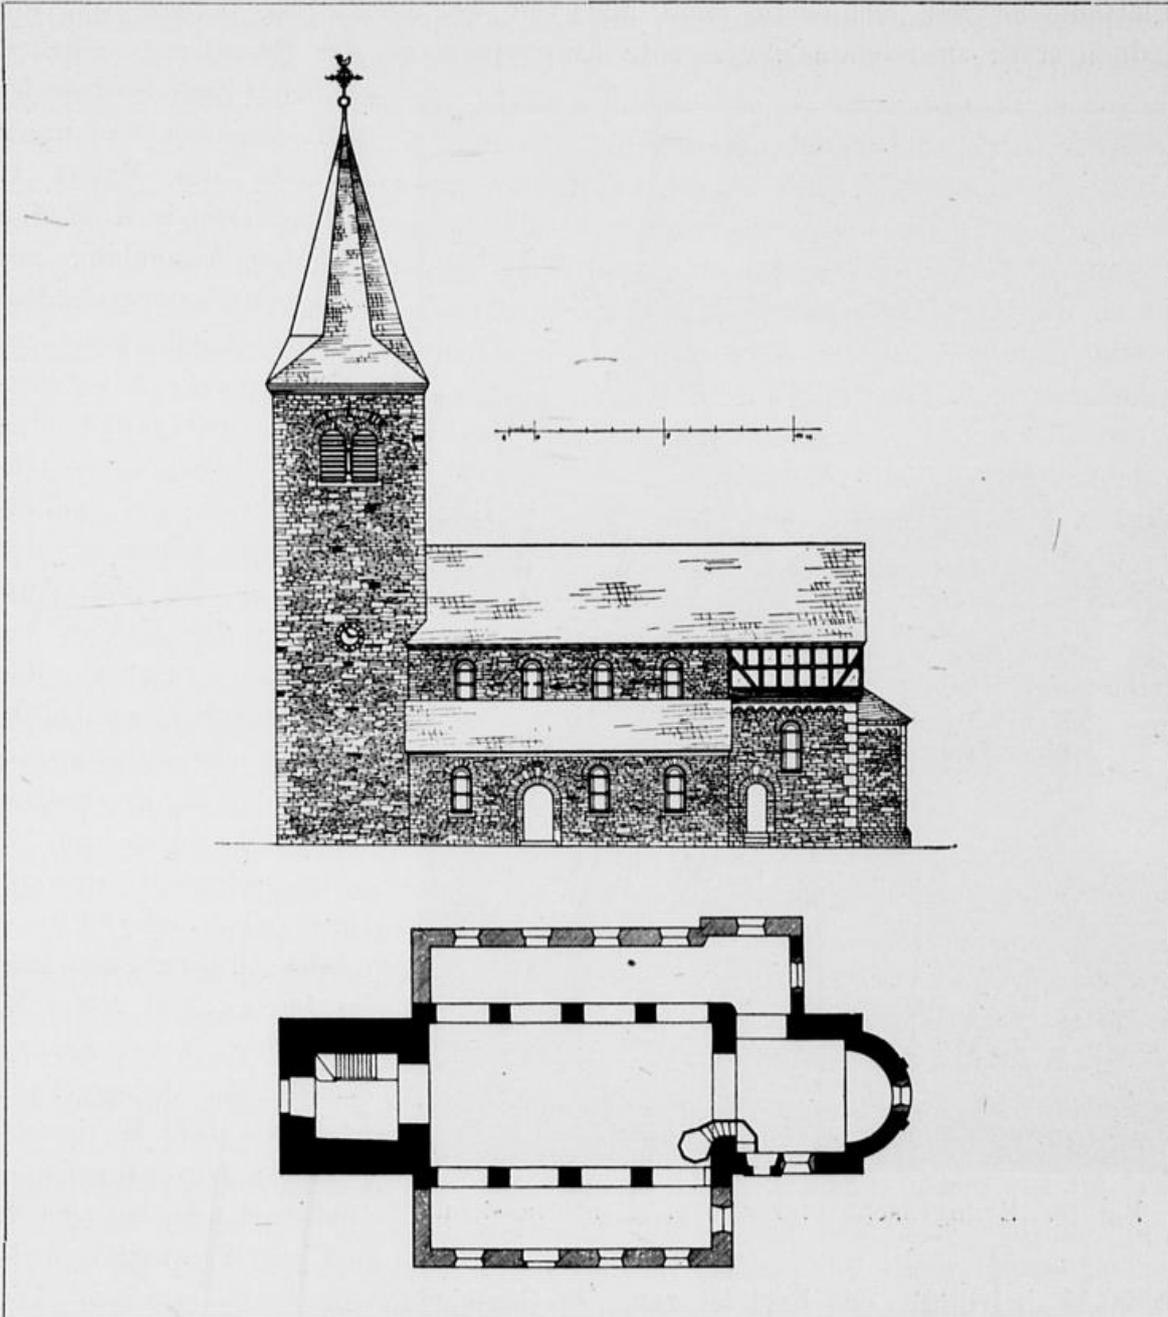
Mehren. Evangelische Pfarrkirche. Südansicht und Grundriss.
